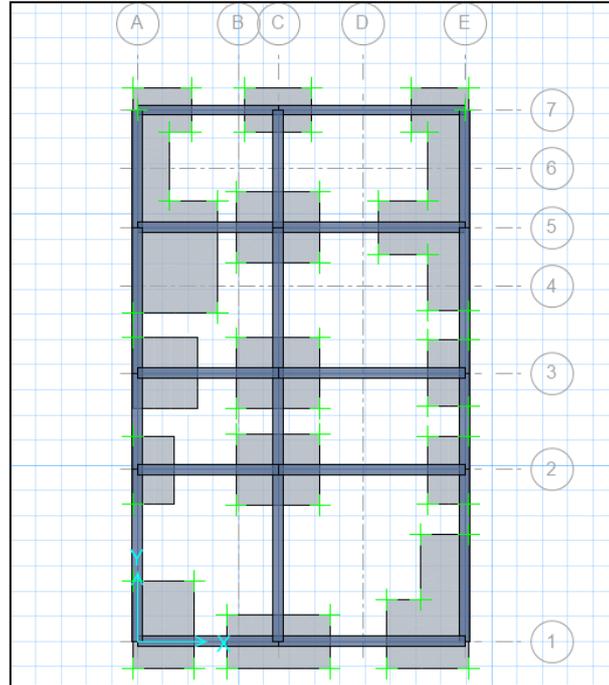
Vista en planta de cimentación (zapatas conectadas)
